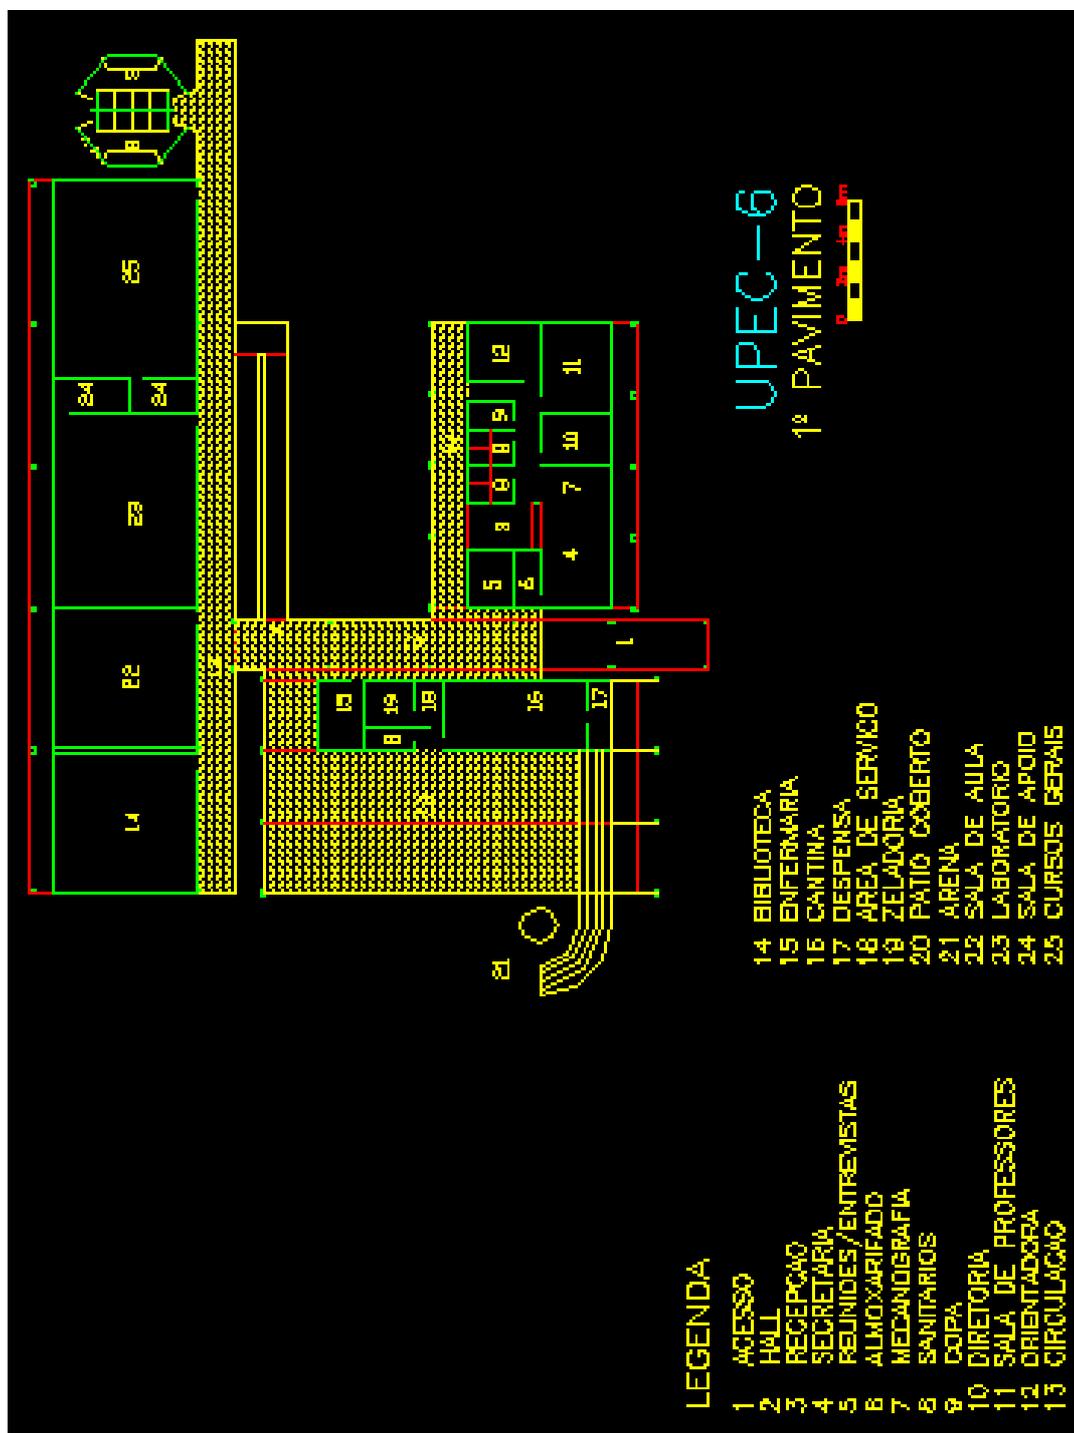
UPEC-6 / PLANTA 1º NÍVEL
